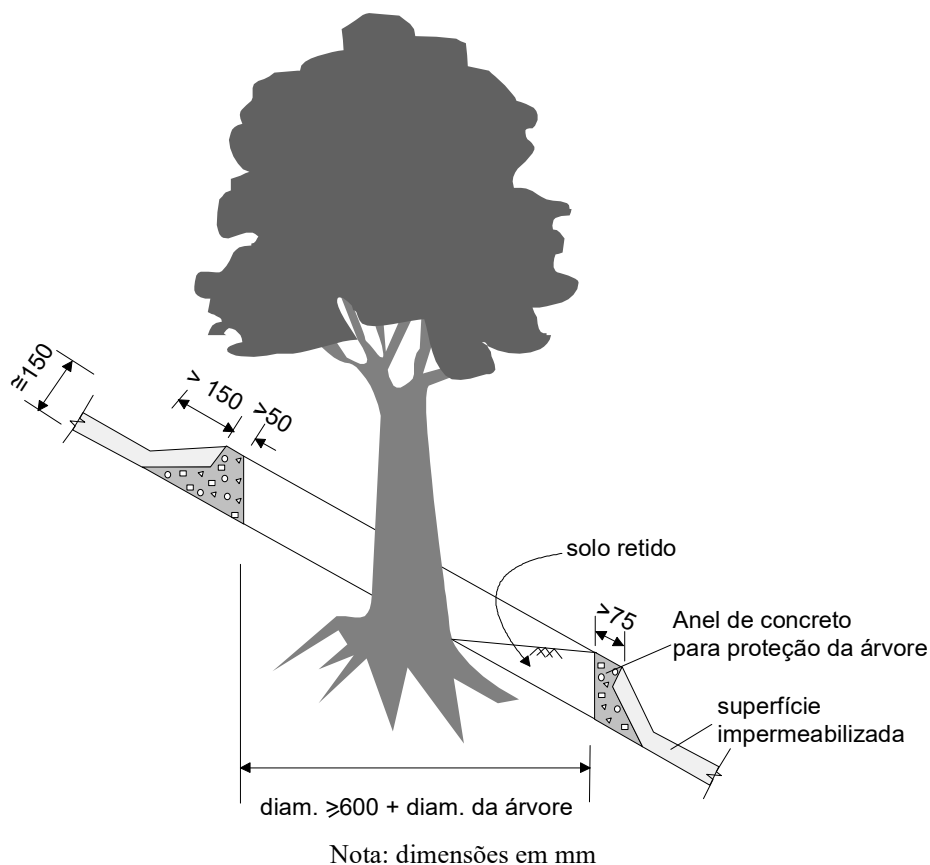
Detalhe de plantio de vegetação em taludes com proteção impermeável (GCO, 1984)
